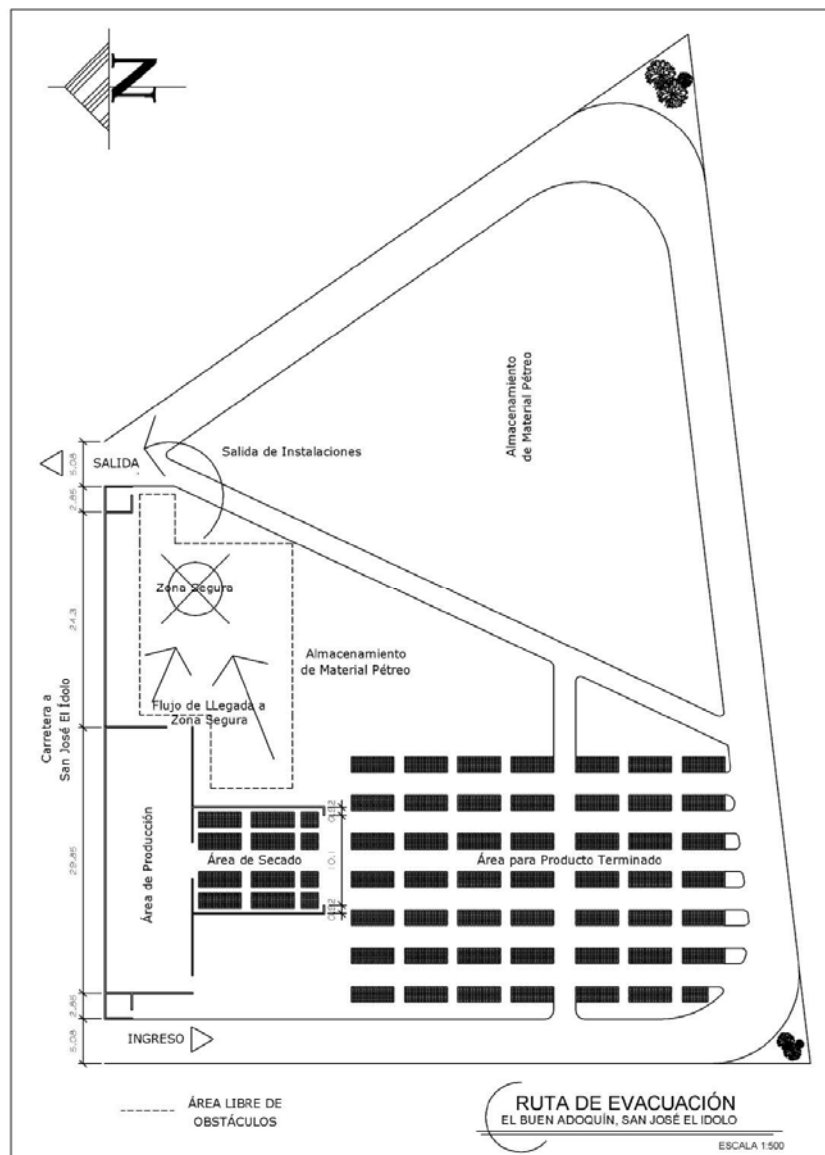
Planta de Conjunto Proyecto San José el Idolo.
